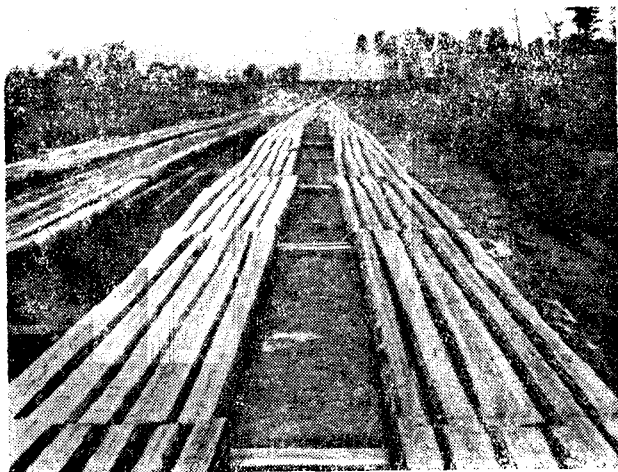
11. Колейное железобетонное покрытие на автомобильной дороге
